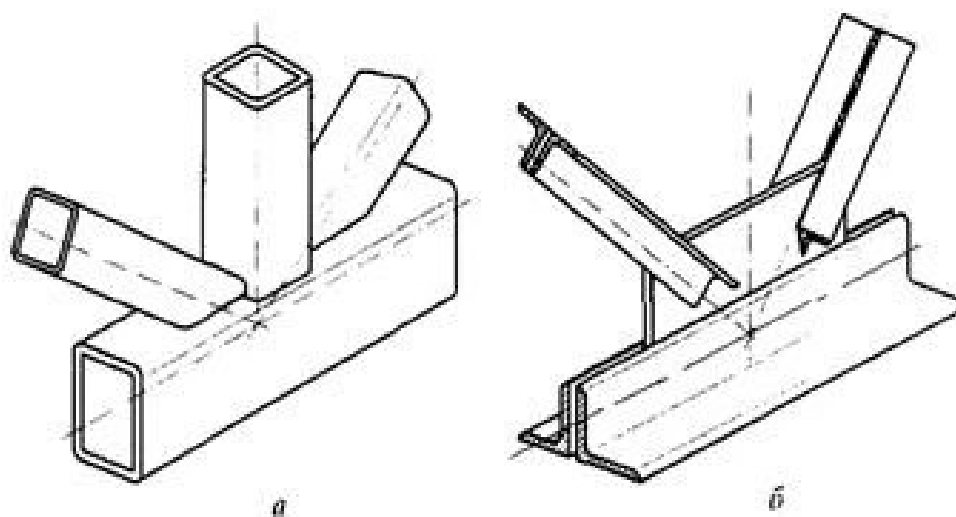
узлы фермы: а — с непосредственным примыканием элементов; б — на фасонках
